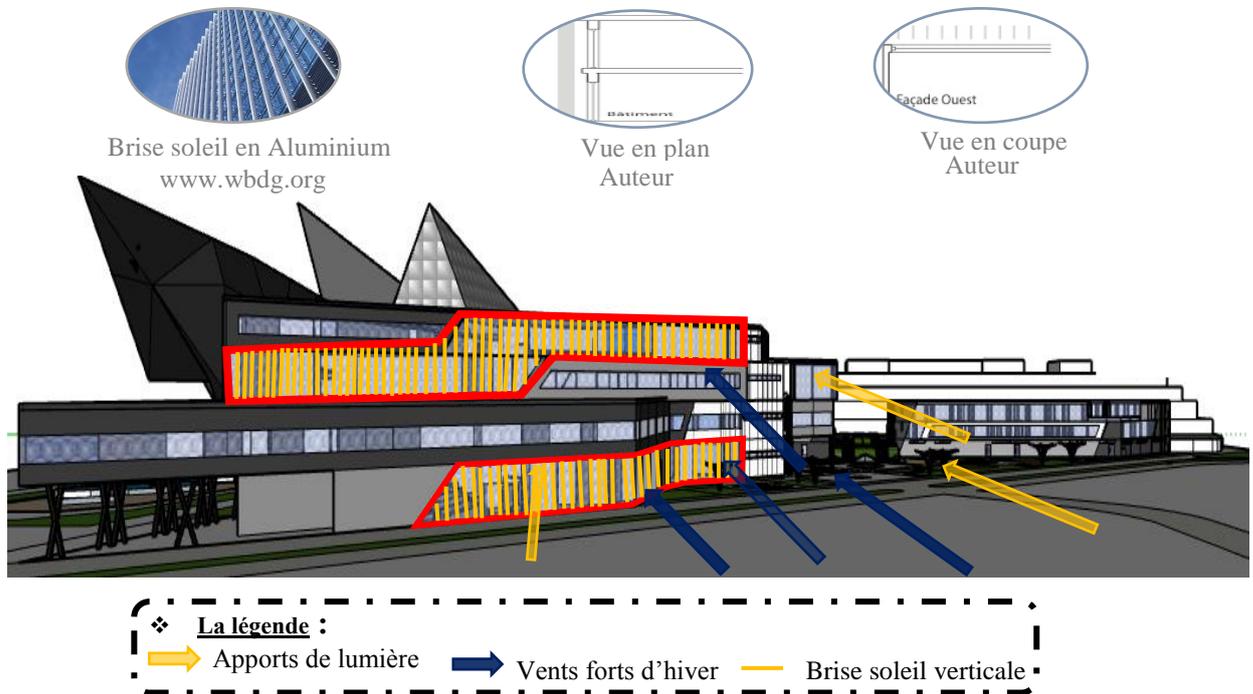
Schémas des brises soleil verticales sur la Façade ouest
